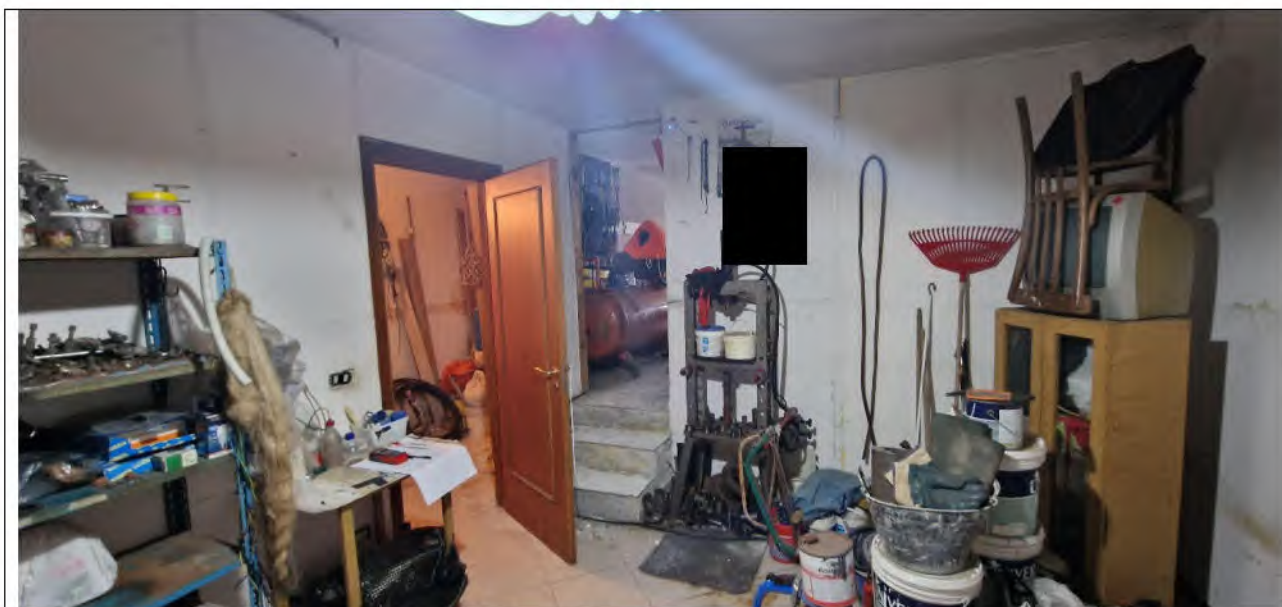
Lotto 2 – Particolare apertura porta su vano del sub 2
